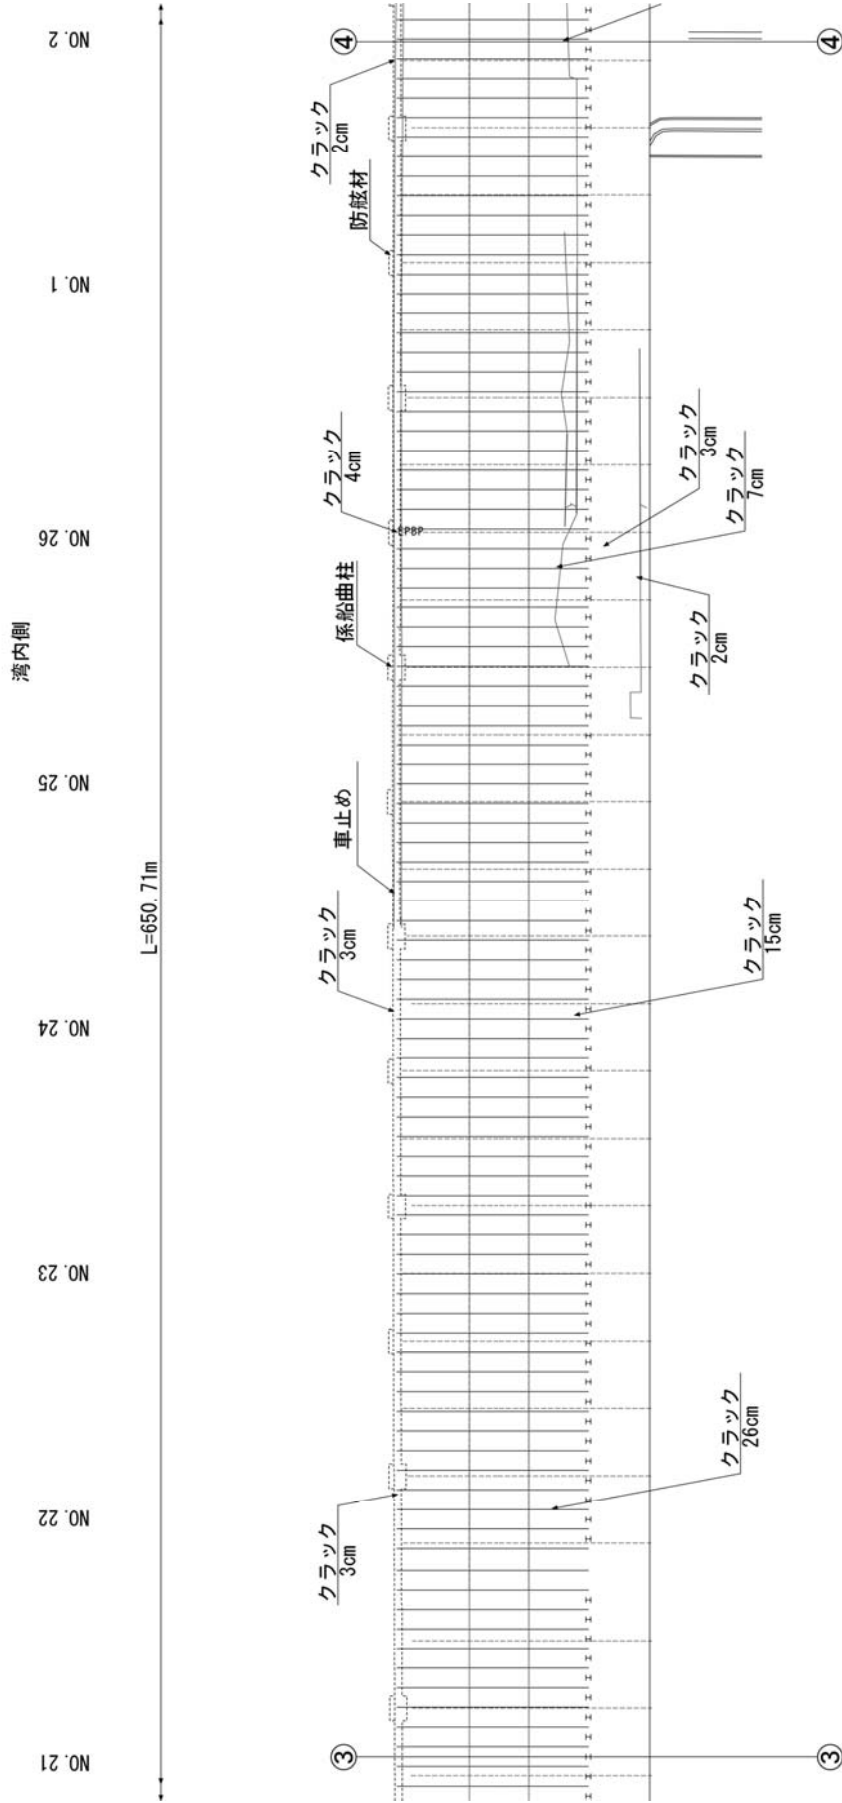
(b) 箱崎埠頭-7.5m 岸壁の被災状況詳細平面図
